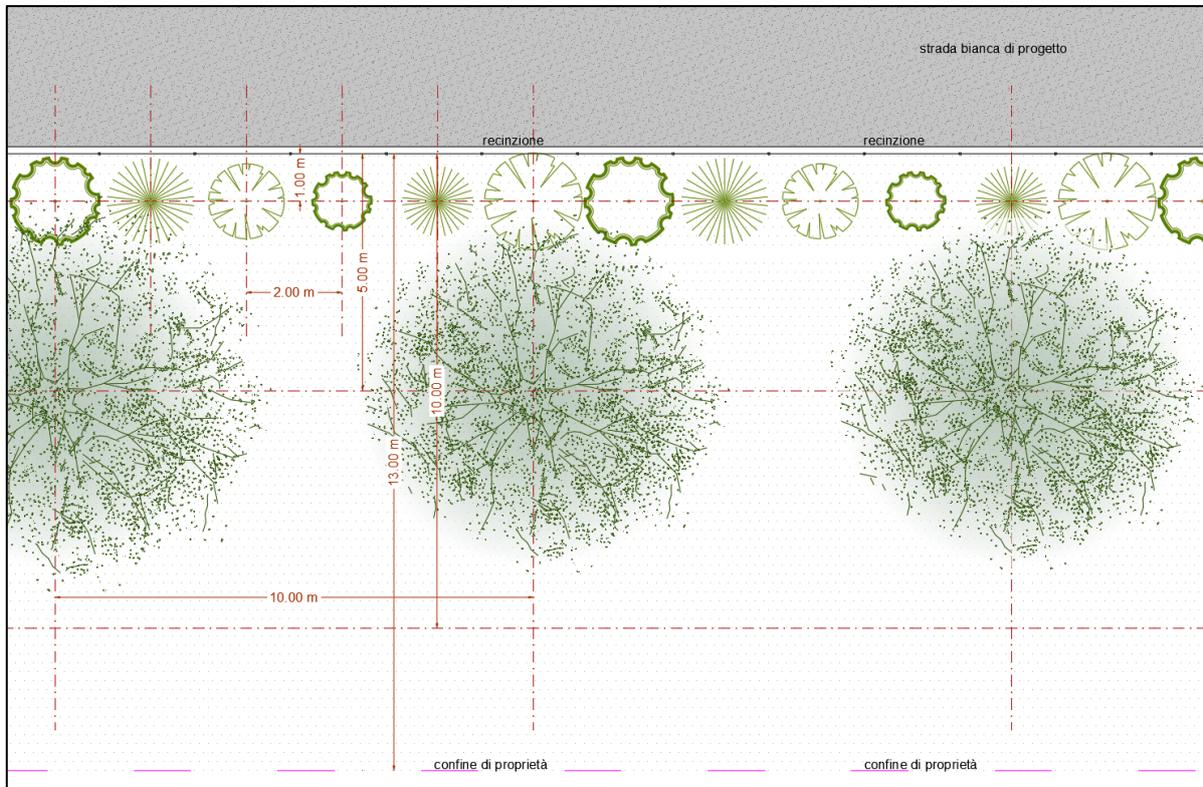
Esempio di fascia di mitigazione perimetrale di progetto
